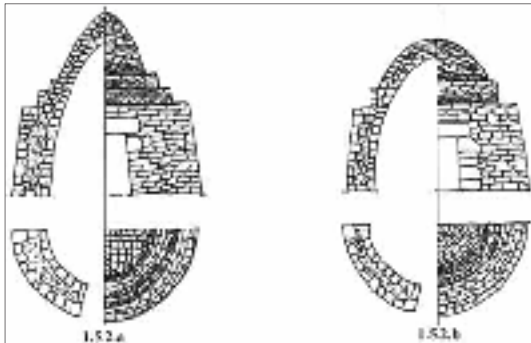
Construcciones de perfil escalonado y elementos superpuestos,
